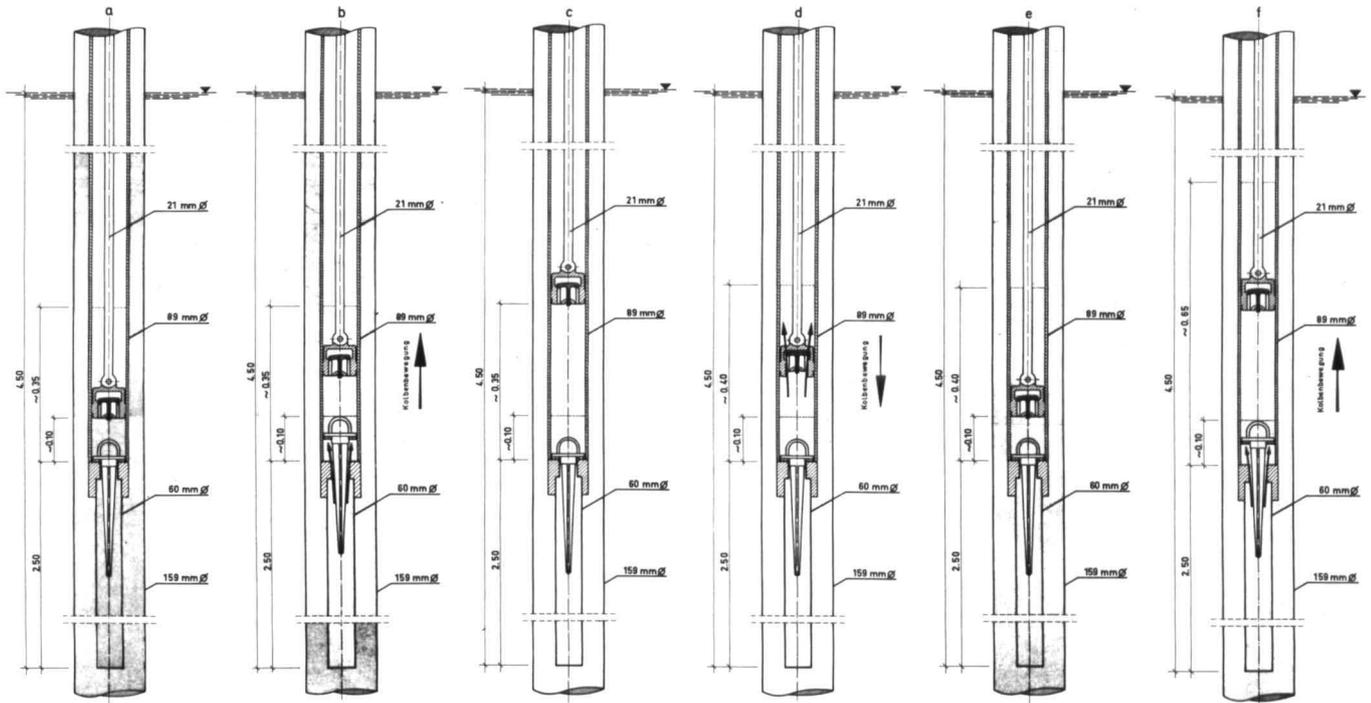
Arbeitsweise des Pumpwerks eines Berliner Straßenbrunnens. Kolbenbewegung (Ansaugen und Heben des Wassers). a) Tiefste Lage des Kolbens (das Wasser befindet sich oberhalb des Kolbens; Ventil im Kolben geschlossen; Ventil im Saugrohr geschlossen). b) Ansaugen des Wassers (Ventil im Kolben geschlossen; Ventil im Saugrohr geöffnet). c) Höchste Lage des Kolbens (Ventil im Kolben geschlossen; Ventil im Saugrohr geschlossen). d) Mittlere Lage des Kolbens (das Wasser wird durch die Kolbenöffnung in den Raum des Saugrohres oberhalb des Kolbens gedrückt; Ventil im Kolben geöffnet; Ventil im Saugrohr geschlossen). e) Tiefste Lage des Kolbens (Ventil im Kolben geschlossen; Ventil im Saugrohr geschlossen). f) Ansaugen und Heben des Wassers / fast höchste Lage des Kolbens (Wasser wird angesaugt; das Wasser oberhalb des Kolbens wird gehoben; Ventil im Kolben geschlossen; Ventil im Saugrohr geöffnet).
